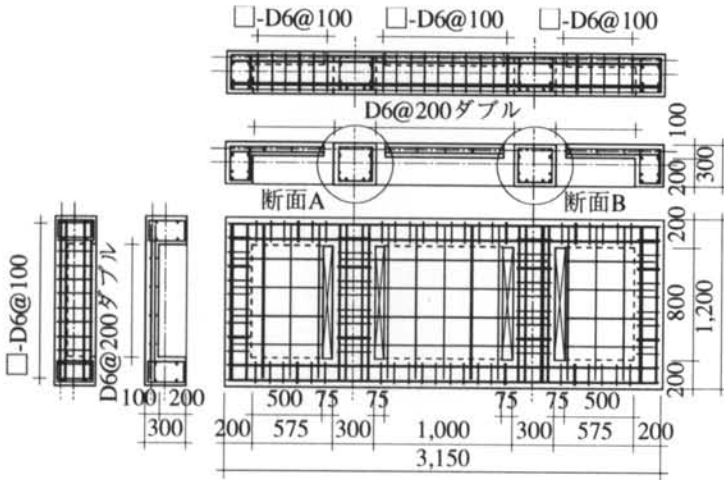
壁付き柱試験体の形状・寸法・配筋 (No.6 試験体)
